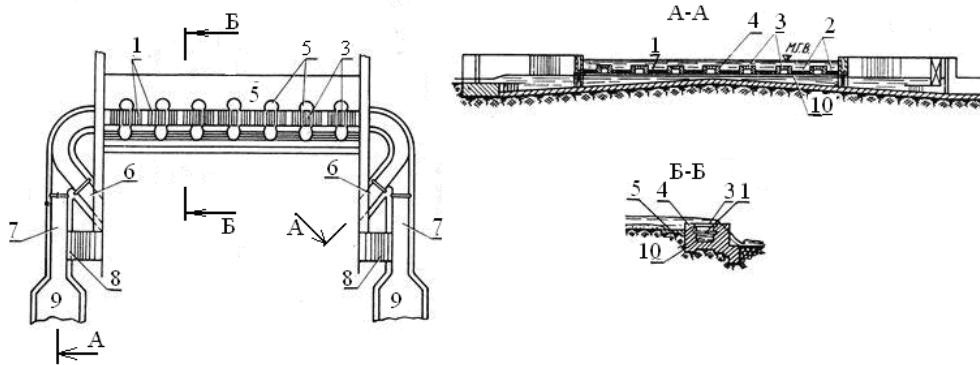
Схема решетчатого сооружения, предложенная Н.Ф. Даниеля: 1 – решетки нижнего яруса; 2 – сплошное перекрытие; 3 – решетки верхнего яруса; 4 – бычки; 5 – бетонный понур; 6 – сбросной канал; 7 – деривационный канал; 8 – водослив; 9 – отстойник; 10 – водозаборная галерея
